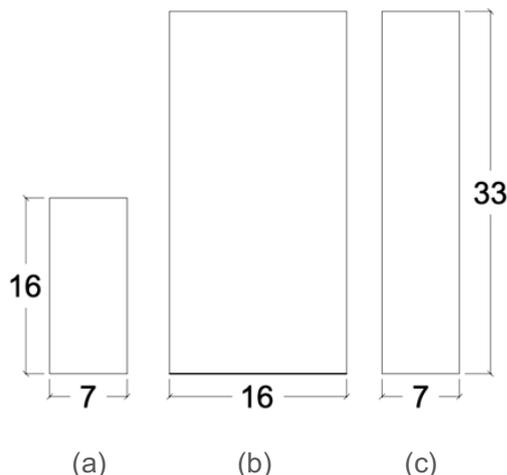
dimensões da edificação (a) projeção superior (b) fachada principal (c) fachada lateral.
